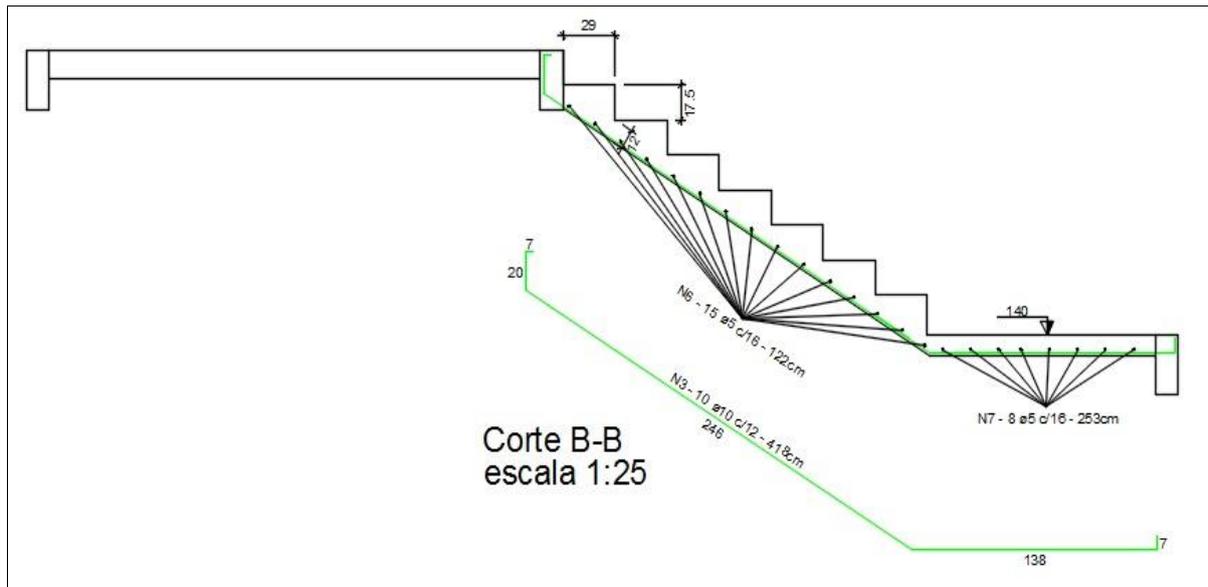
Detalhamento do segundo lance de escada, Corte B-B
